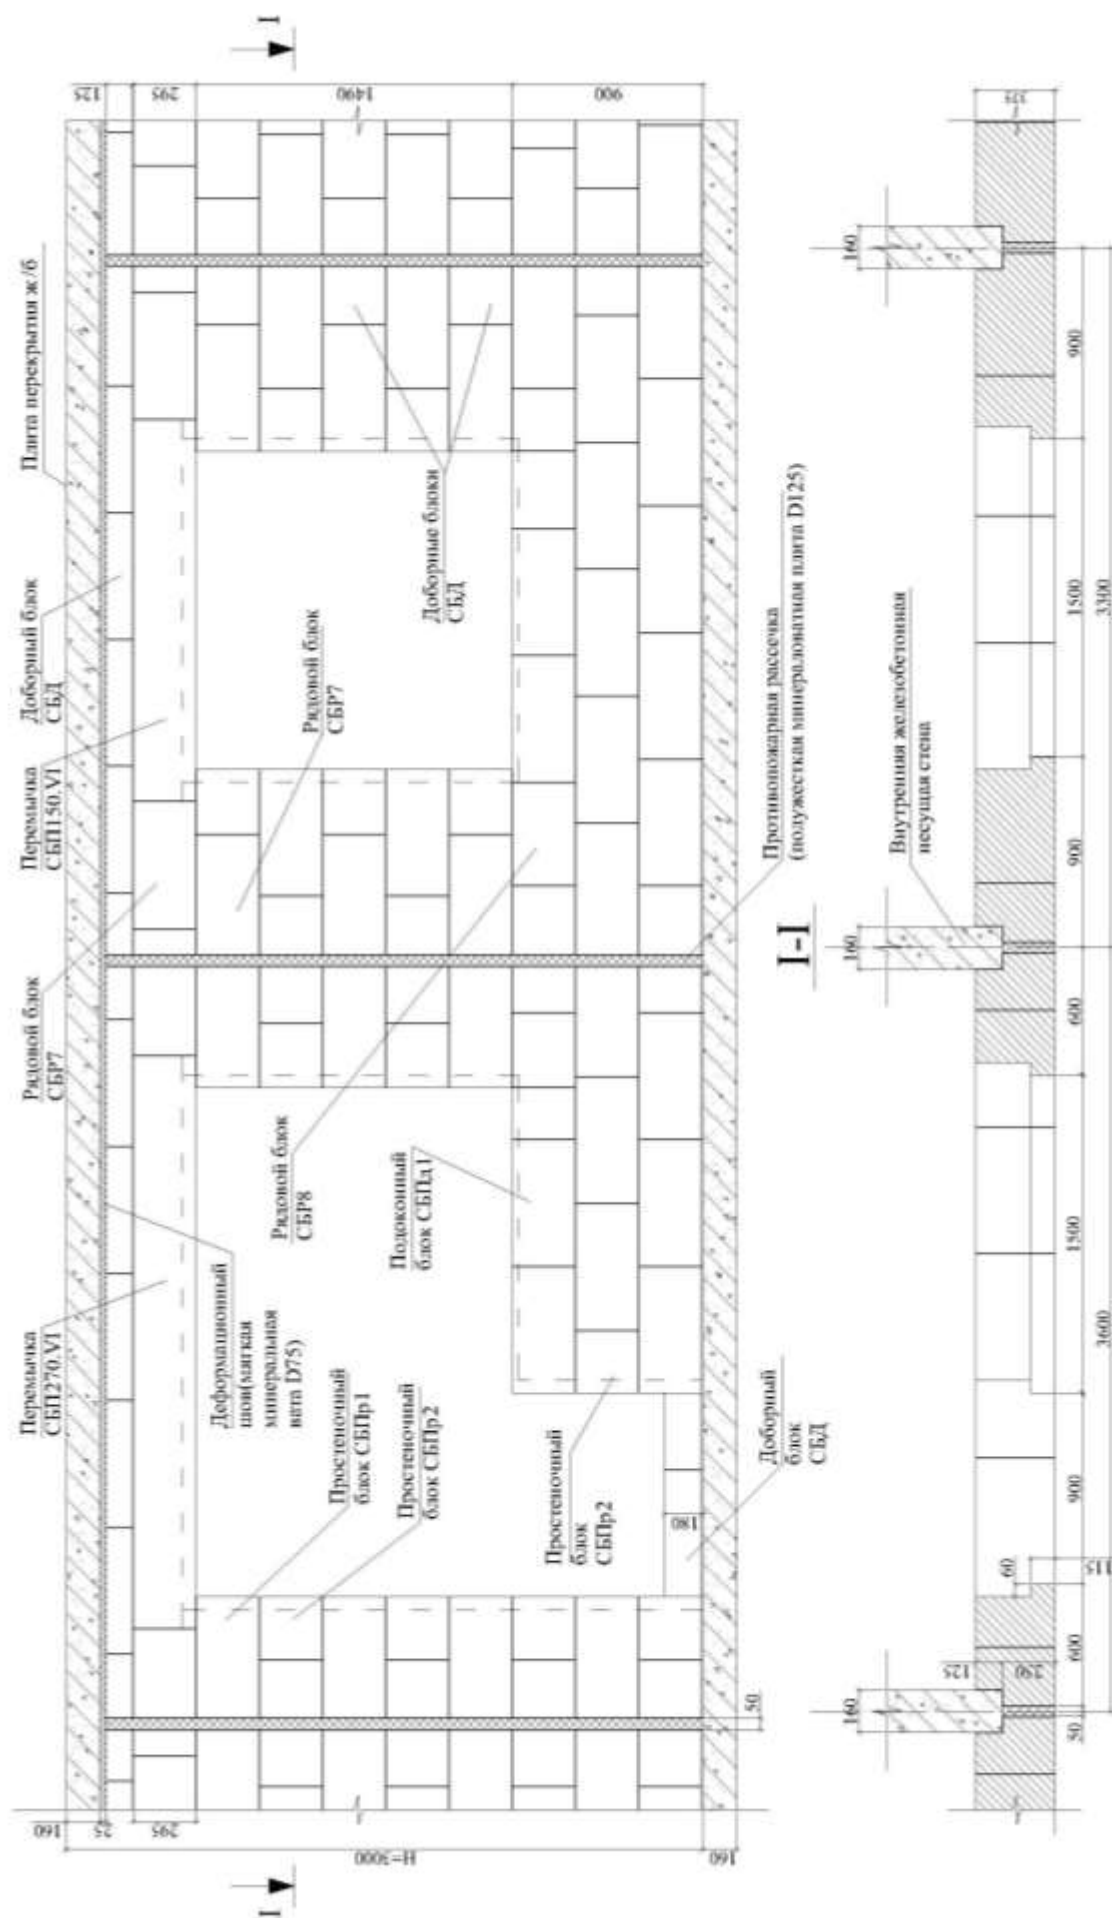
Пример раскладки ПСБ блоков и перемычек производства ЗАО "ЮНИКОН-ЗСК" при монтаже наружной стены здания с кирпичным фасадом (толщина блоков 375 мм)
